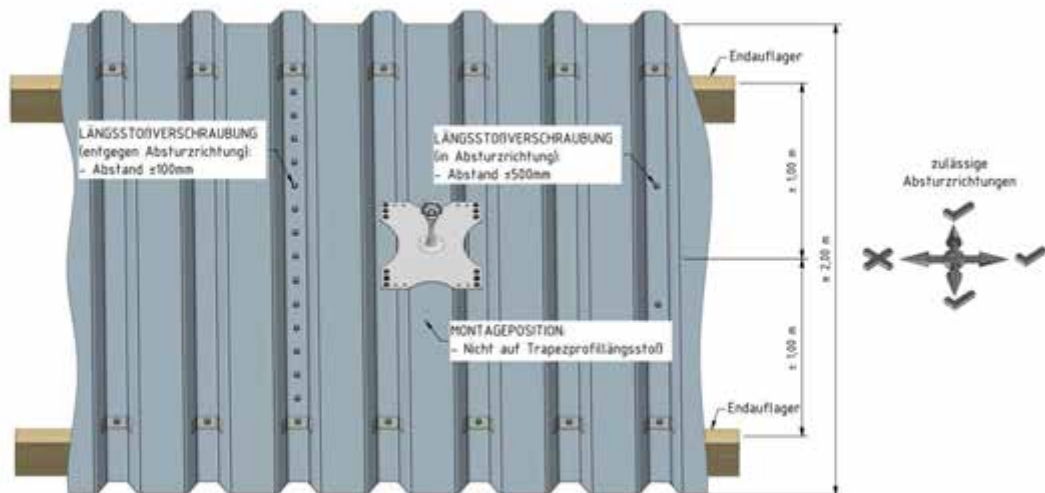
Montagevorgaben auf Trapezprofil (Negativlage) bei Montage neben dem Längsstoß mit Angabe der zulässigen Absturzrichtung
